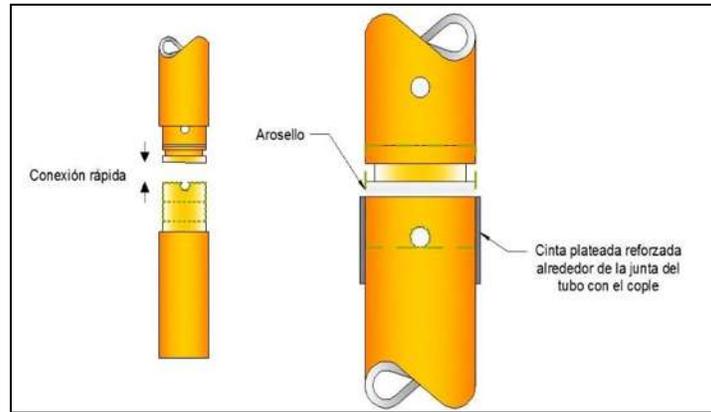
Conexión de tramos de tubería en la instalación de un inclinómetro y detalle de unión.
